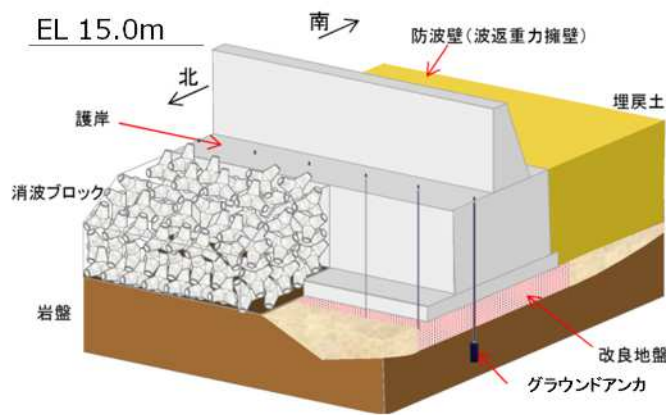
防波壁（波返重力擁壁）の縦断面図
